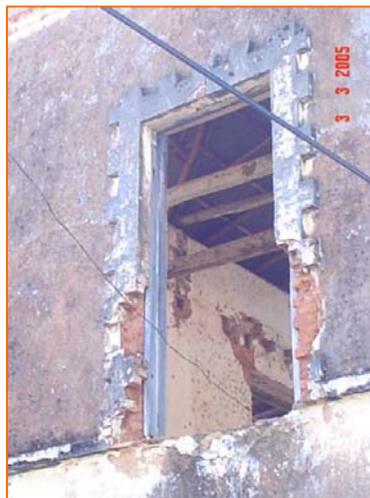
Vano de puerta-balcón de la fachada lateral. Decoración con molduras en forma de denticulado. Cod. RF-SD-024, fotografía: M. Egui B.
